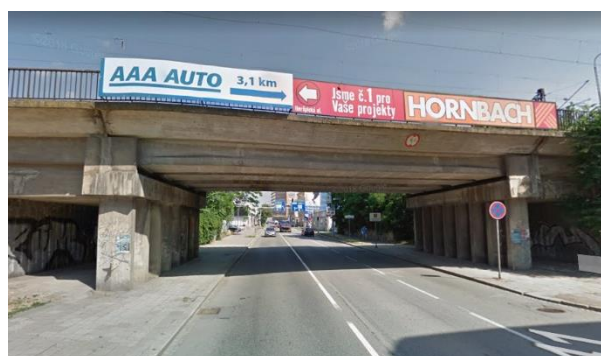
Trasa pro dopravu betonu 4,8 km
